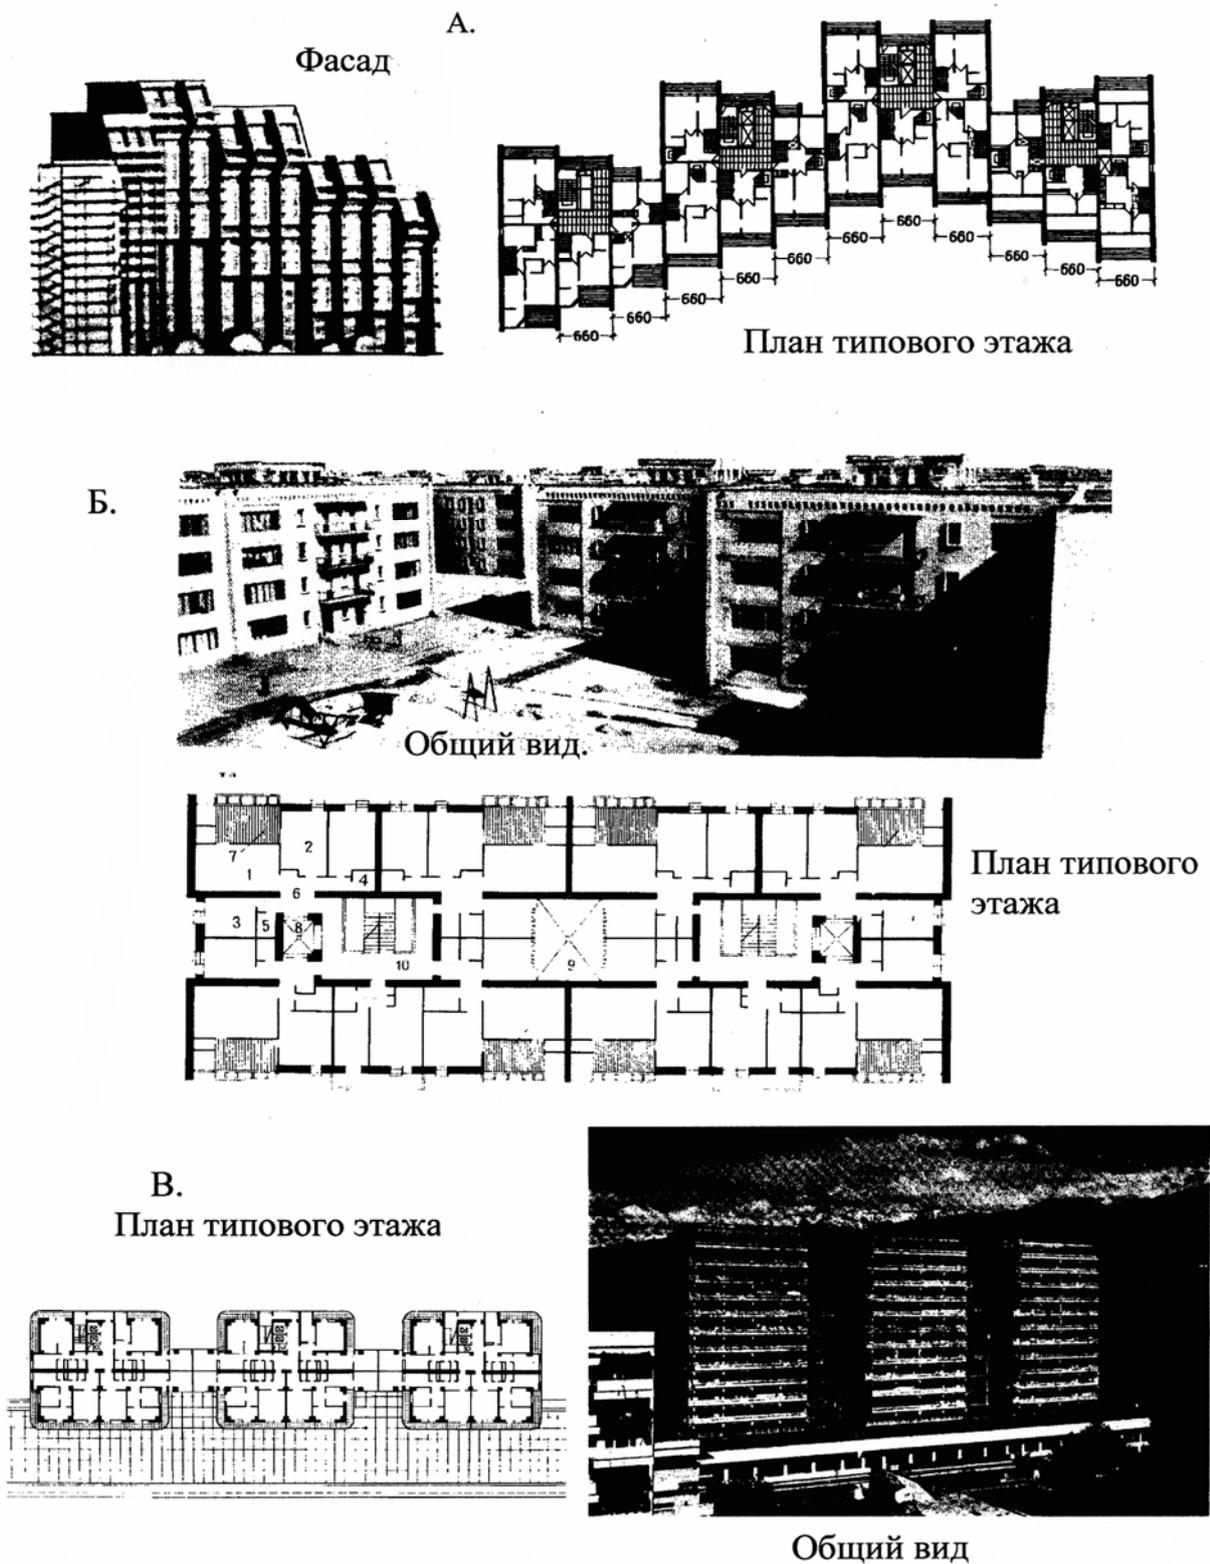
А – конструктивная система жилого дома с поперечными несущими стенами; Б – жилой дом с продольными несущими стенами. Фасад здания плоский, нарезка помещений в одном пролете свободная. Теплопотери здания минимальные; В – каркасный вариант конструктивной системы жилого дома. На фасаде здания видны торцы консолей каркаса
